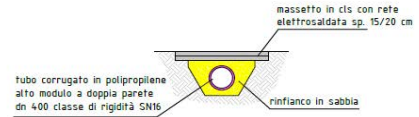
Tipologia di attraversamento stradale e cavalcafosso in progetto
